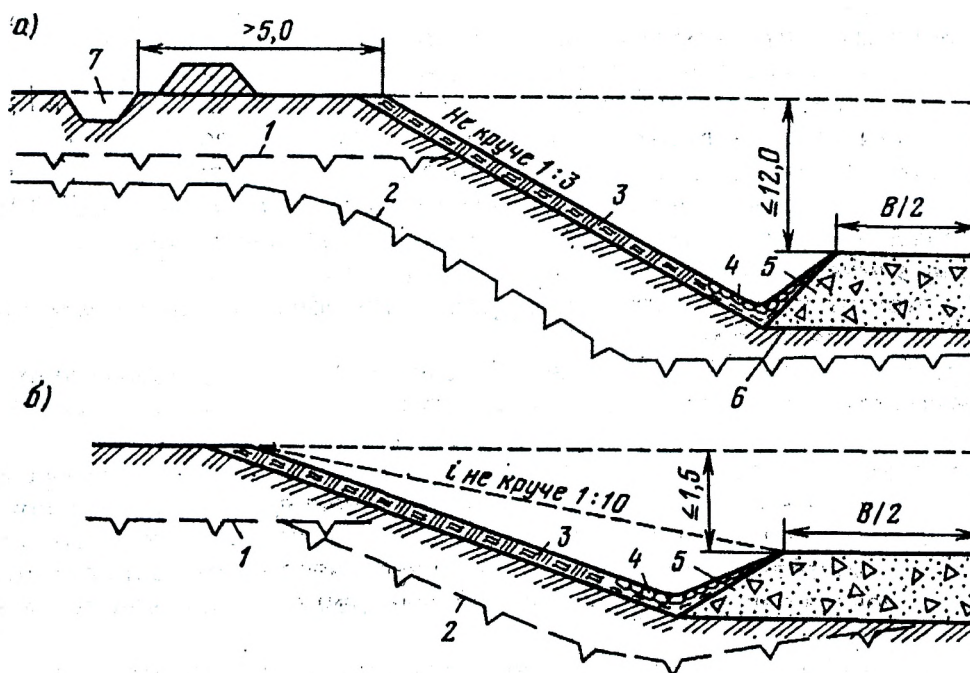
Поперечные профили выемок в слабольдонасыщенных грунтах: а – глубокая выемка; б – мелкая выемка; 1 – верхний уровень вечномерзлых грунтов до устройства выемки; 2 – то же, после устройства выемки; 3 – теплоизоляционный слой; 4 – укрепление мощением; 5 – песчано-гравийный грунт; 6 – глинистый грунт; 7 – нагорная водоотводная канава
